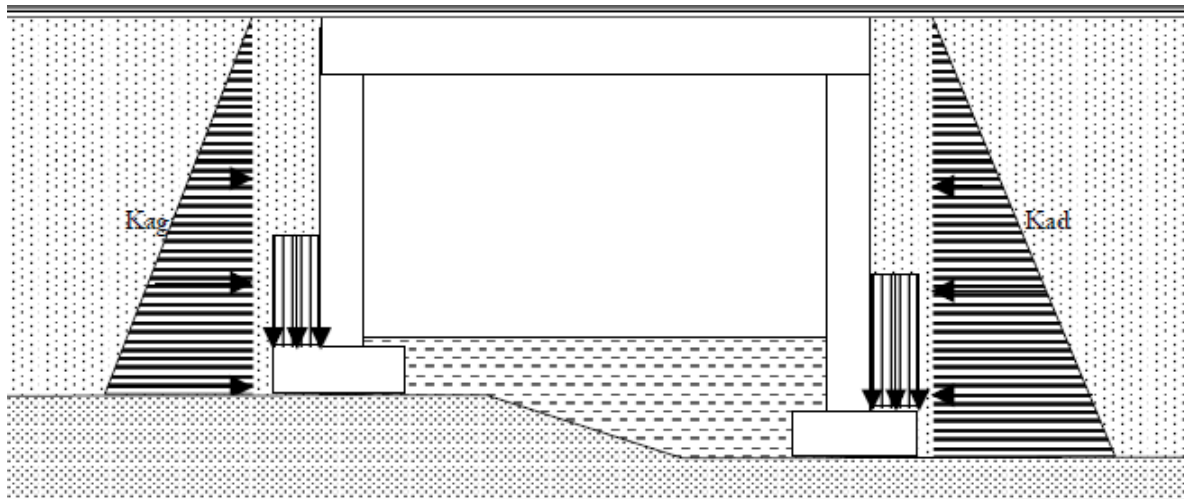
Poussée des terres avec piédroits de hauteur différente
